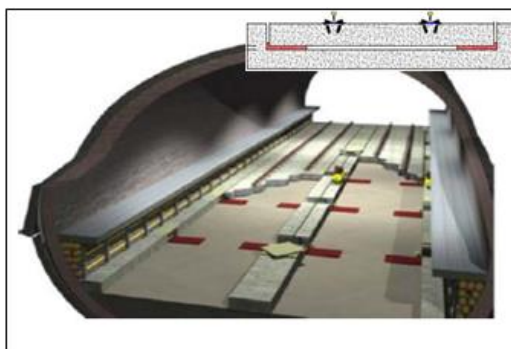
Colocação de uma manta de borracha descontínua em via assente em laje [6]
